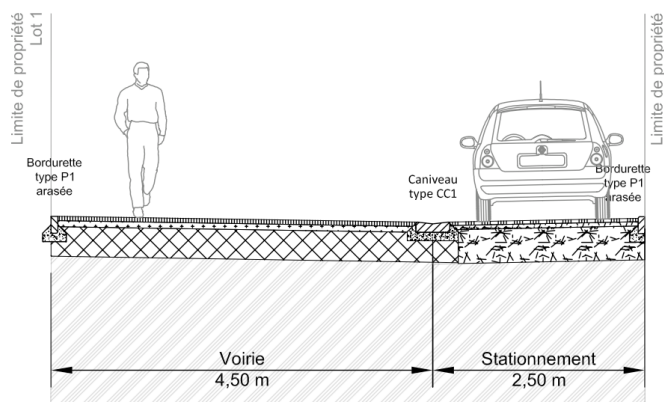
Coupe de principe sur la voie de desserte - sans échelle (source : SODEREF - novembre 2021)
